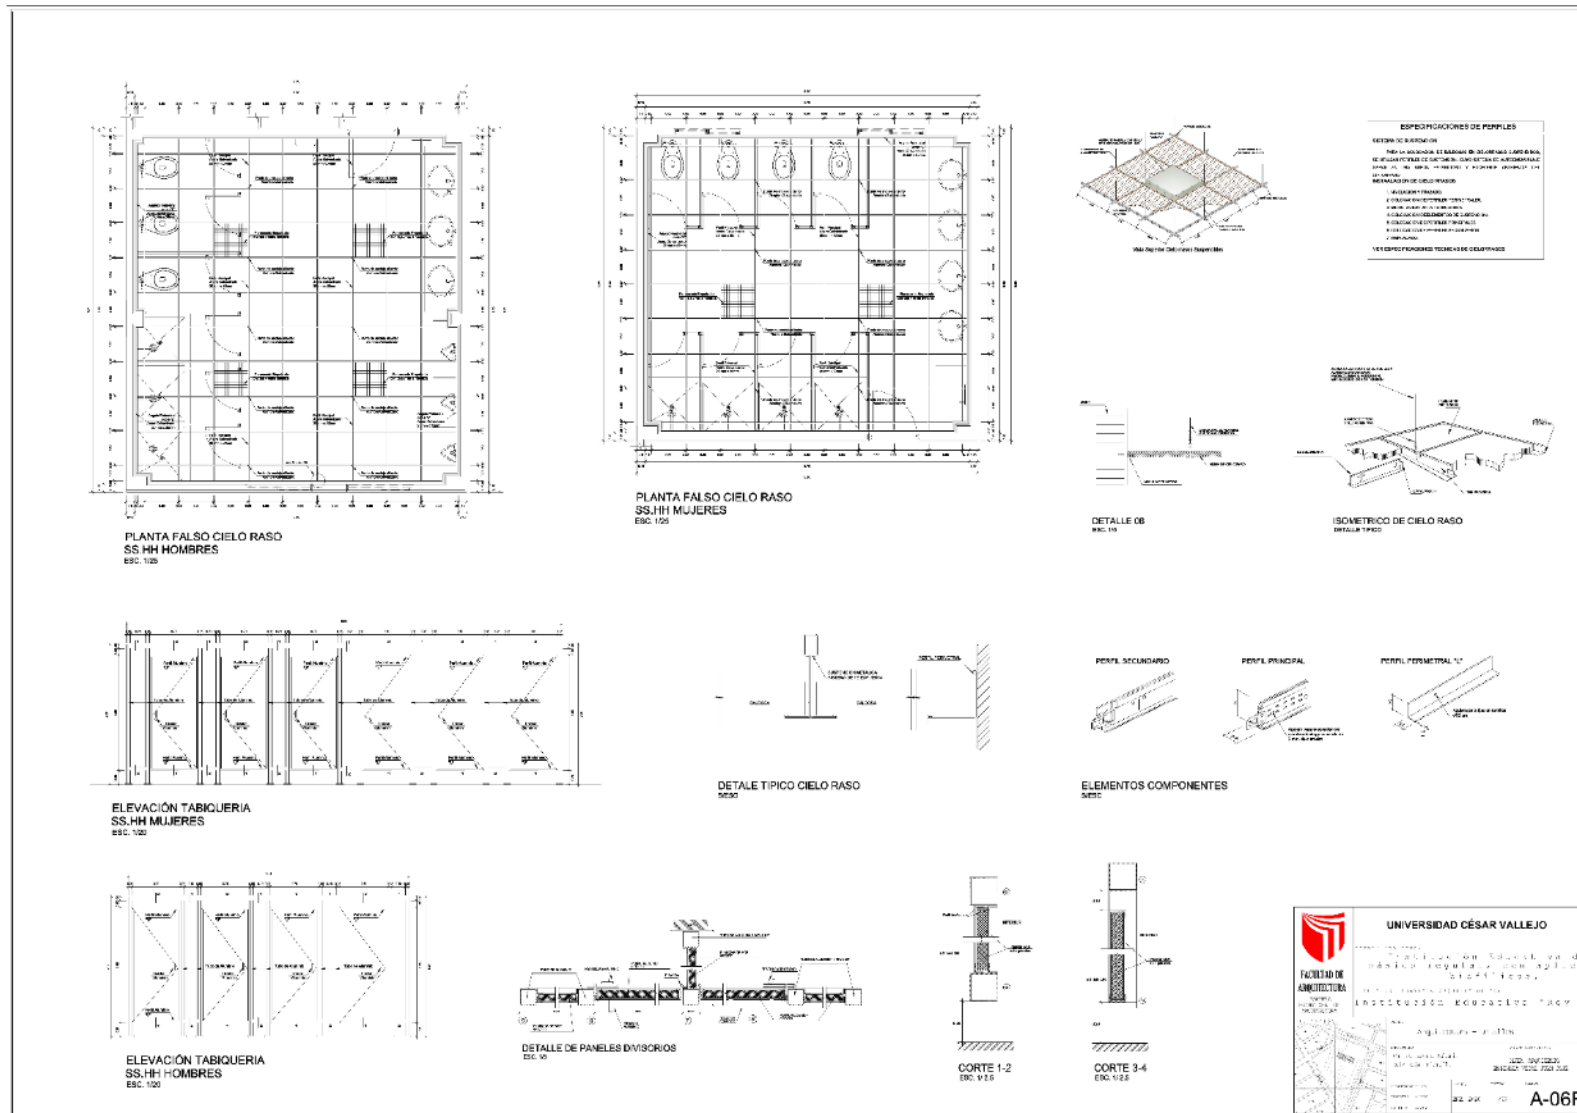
Plano Detalles de servicios higiénicos Bloque "F", Fuente: elaboración propia
